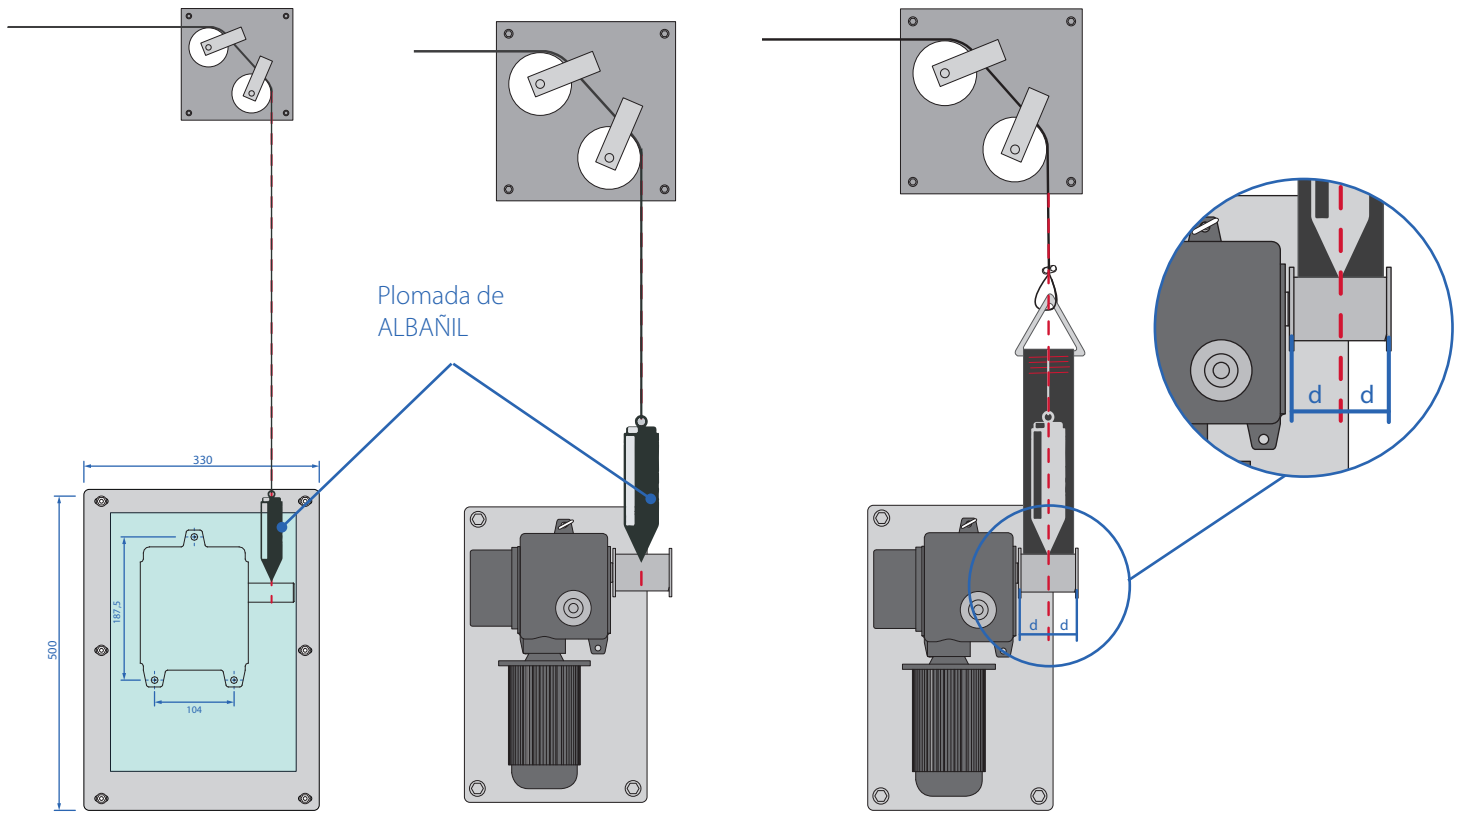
Colocación de la plantilla sobre la chapa, instalar carrete con cincha.
